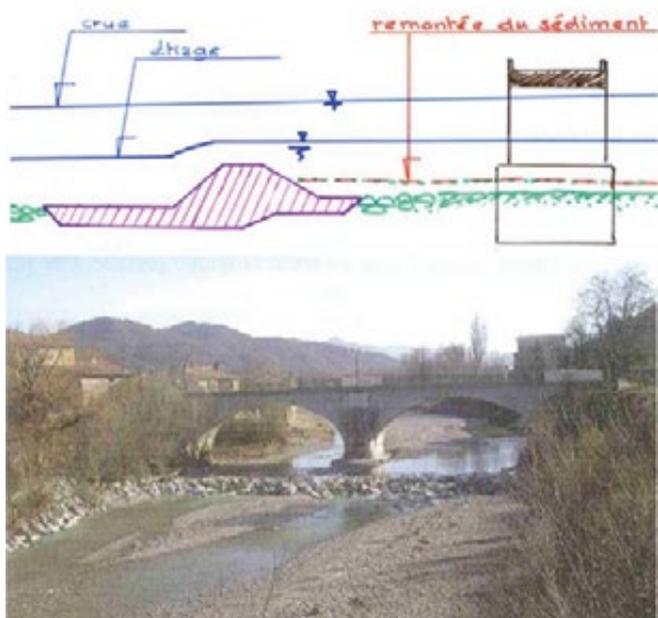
Coupe de principe et illustration de l'interaction d'un seuil avec les fondations d'un ouvrage d'art situé en amont (Crédit JP Levillain)
